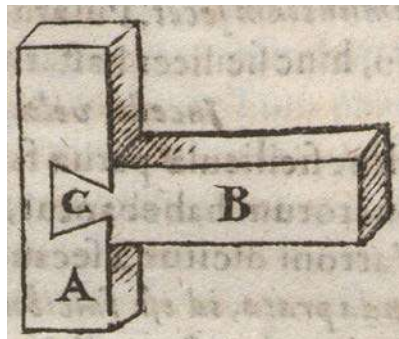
Componentes de la conexión machihembrada cola de pato.
